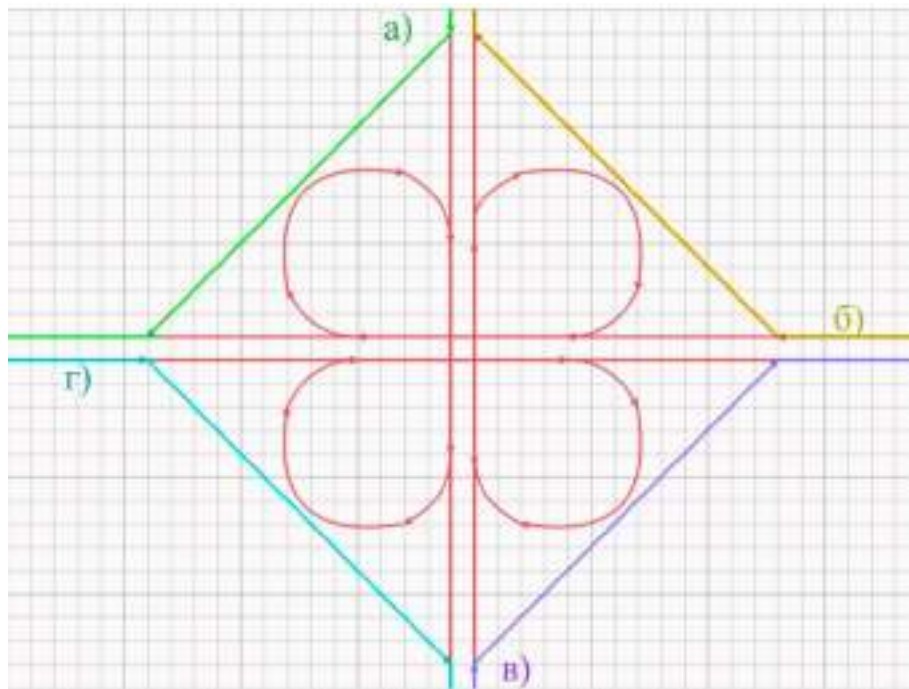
Частини ромбової схеми “Листка конюшини”:
